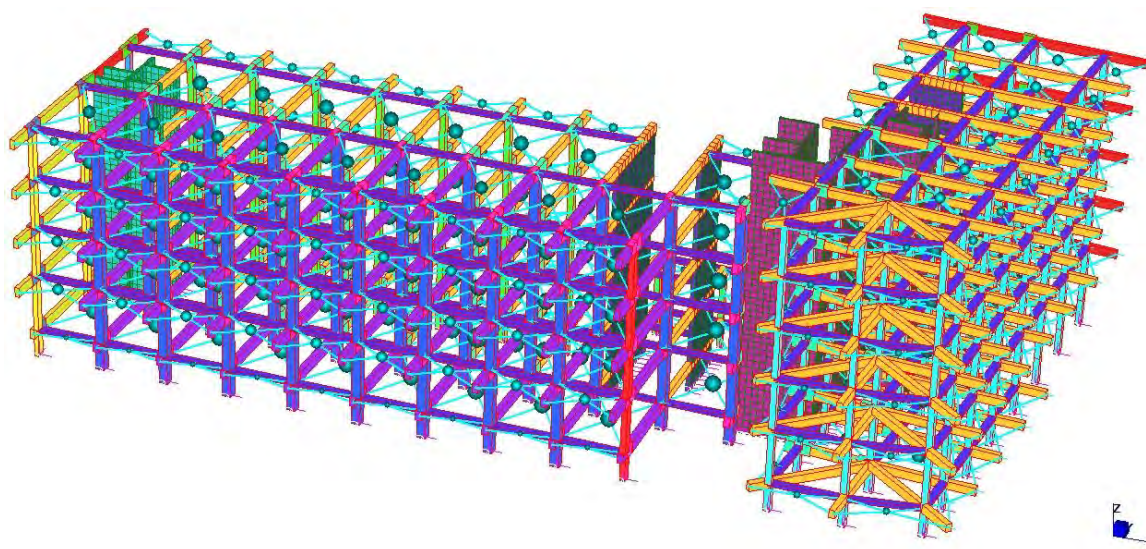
Modello a elementi finiti con vincoli a incastro al suolo, rigid link e masse di piano
